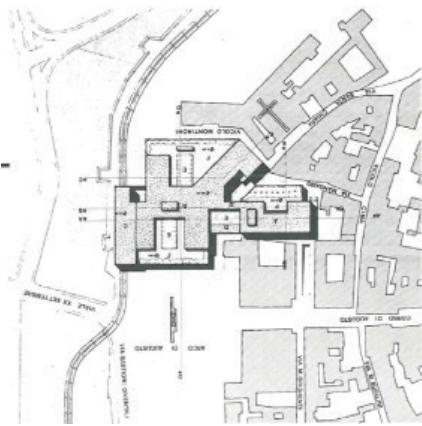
Planimetria del Condensatore collocato presso l'arco di Augusto. De Carlo 1975, p. 40.
